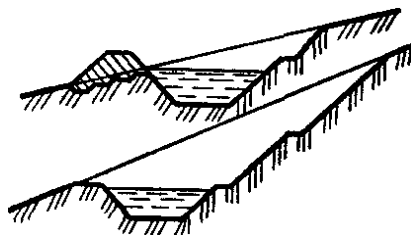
Схеми поперечних переріз каналів на крутому схилі.
